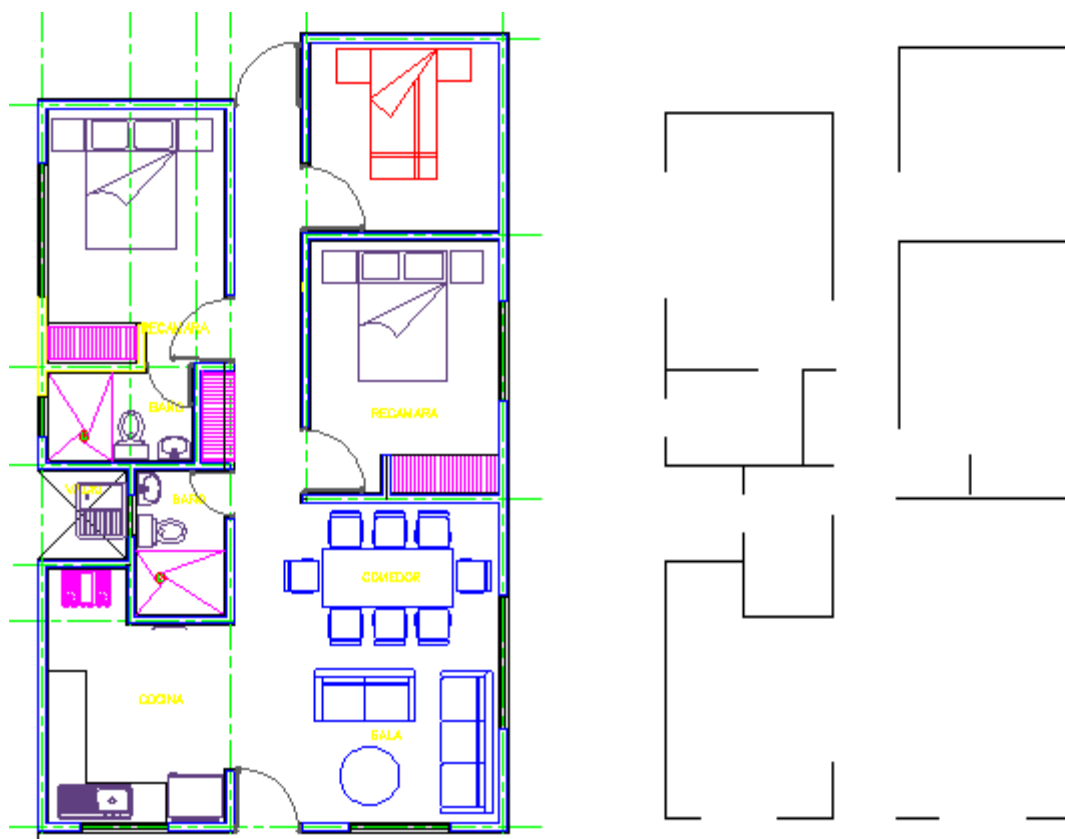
Planta del proyecto de vivienda de interés social junto con sus C_L del muro, base para el modelado del mismo.
